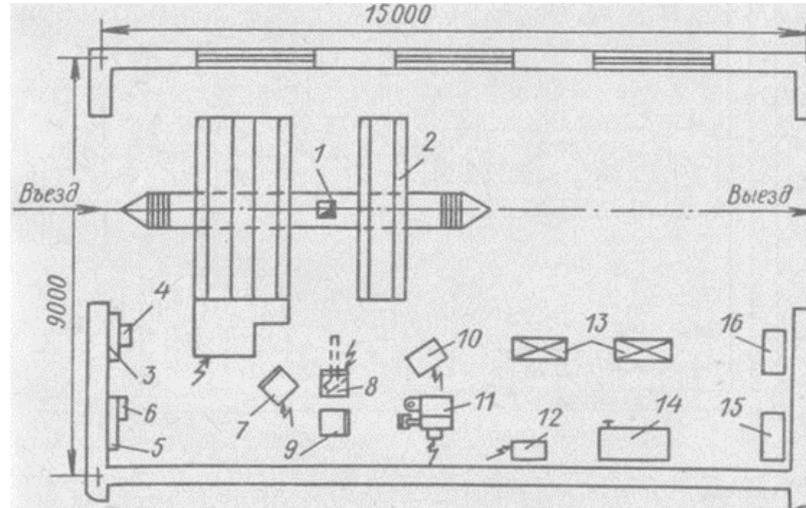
Проект планировки стационарного диагностического поста: 1 - тормозной стенд КИ-8927; 2 - устройство для отвода выхлопных газов; 3 - расходомер; 4 -топливный бак; 5 - ящик с песком; 6 - противопожарный щит; 7,8,9 - стоки: измерительная, переходных, устройств и коммутационная диагностической установки «Урожай-1Т»; 10 - пульт управления стенда КИ-8927; 11 - реостат; 12 - электрошкаф; 13 - стеллаж-подставка; 14 - слесарный верстак; 15 - шкаф для одежды; 16 - письменный стол
